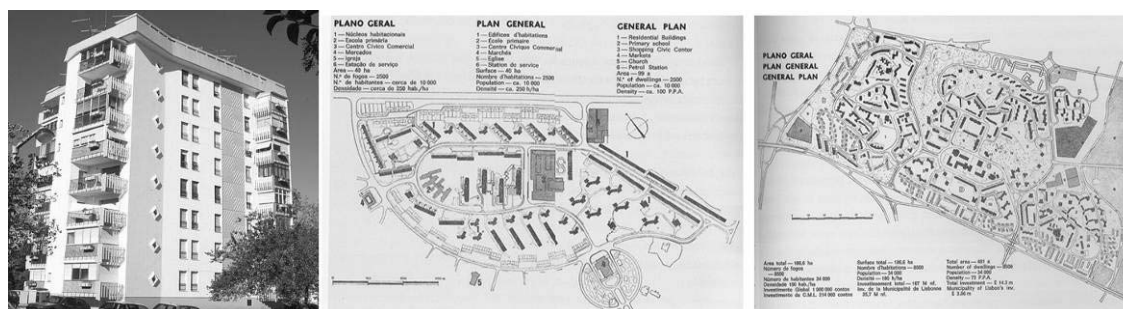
Plano e Imagens Olivais Norte e Sul
